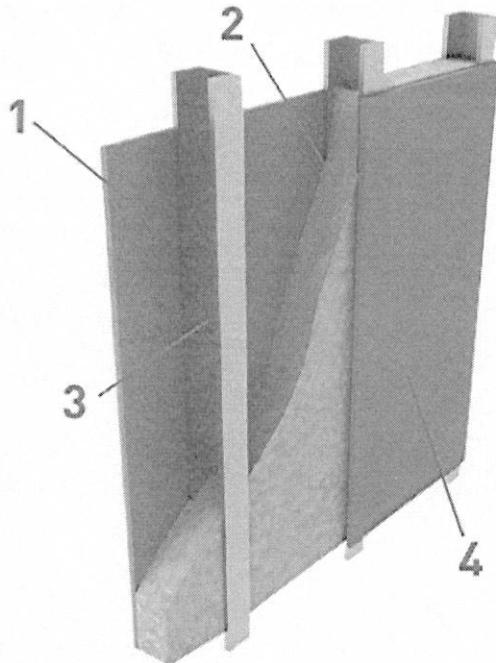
Утепленная перегородка: 1, 4 – листы из гипсокартона, 2 – тепловая изоляция, 3 – каркас из металлического профиля
